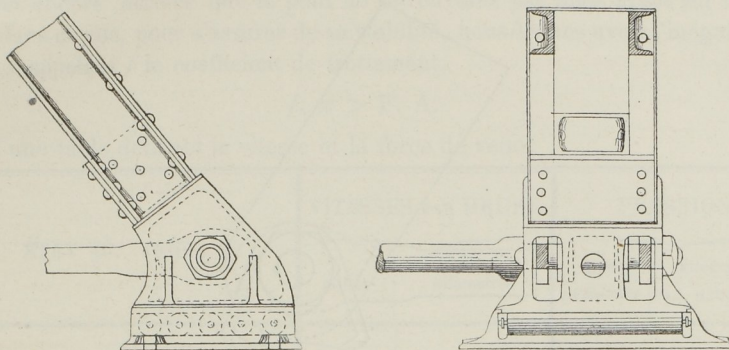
Mode de placement des poutres sur rouleaux ou galets.
